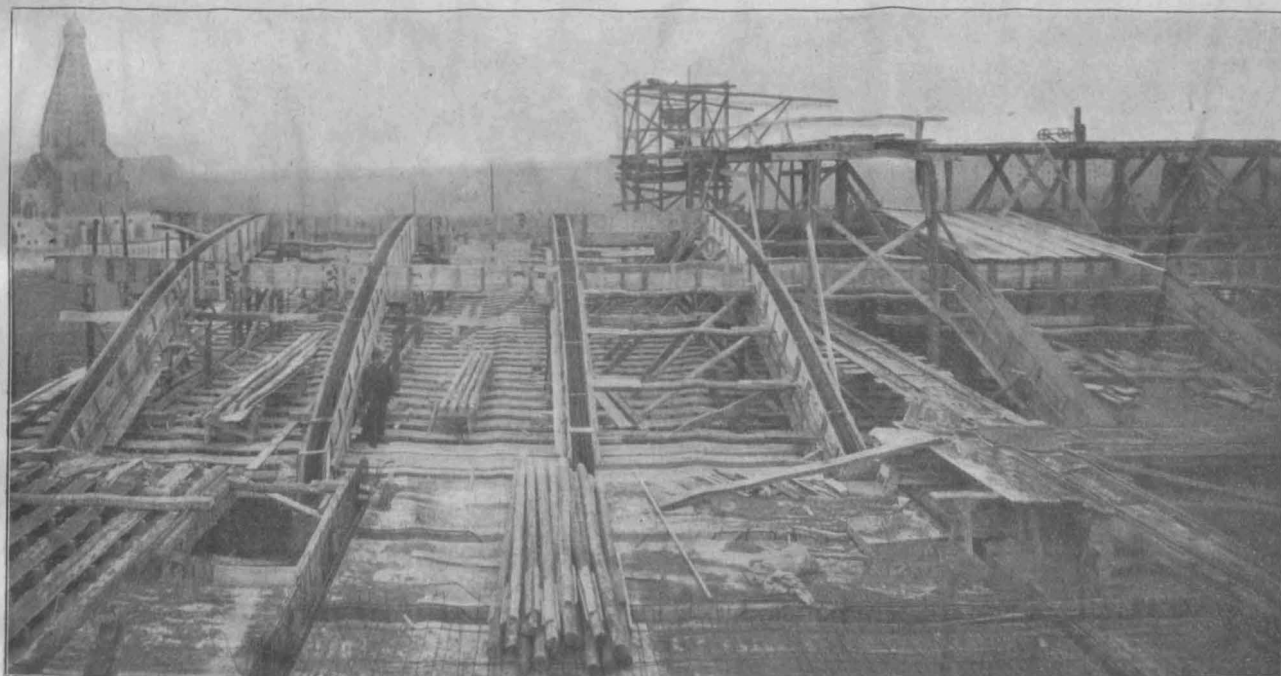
Einrüstung und Einschalung von Dachbindern und Decke über dem großen Lesesaal.
